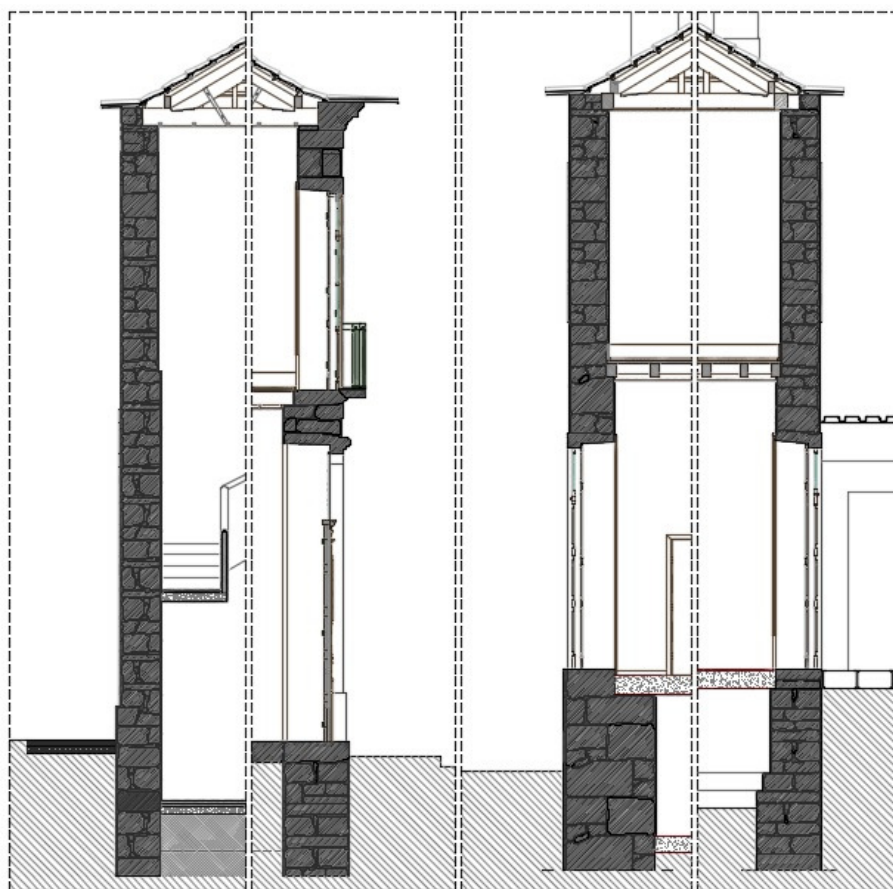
Corte de Fachada (s/escala) – (Autor)
